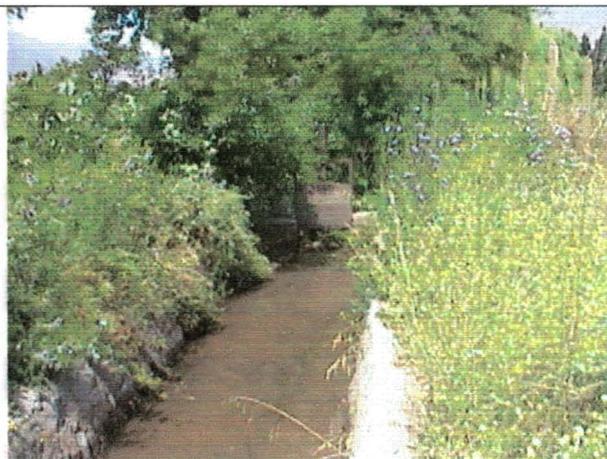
Compuerta de Entrega Canal Derivado Los Lemus
